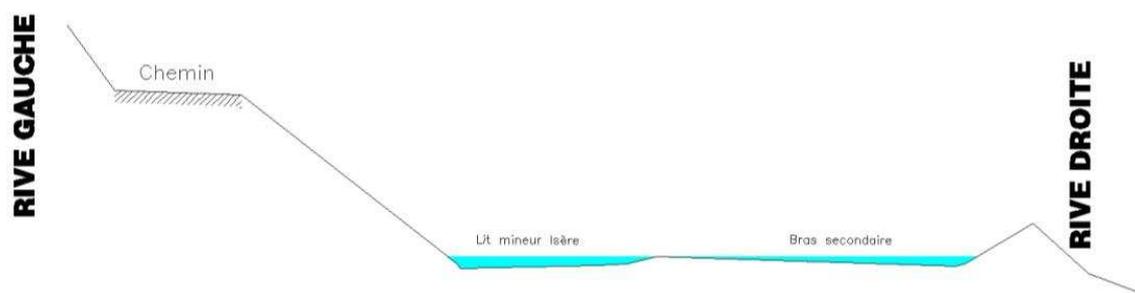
Profil en travers 8 au niveau du bras secondaire de l'Isère préservé.
